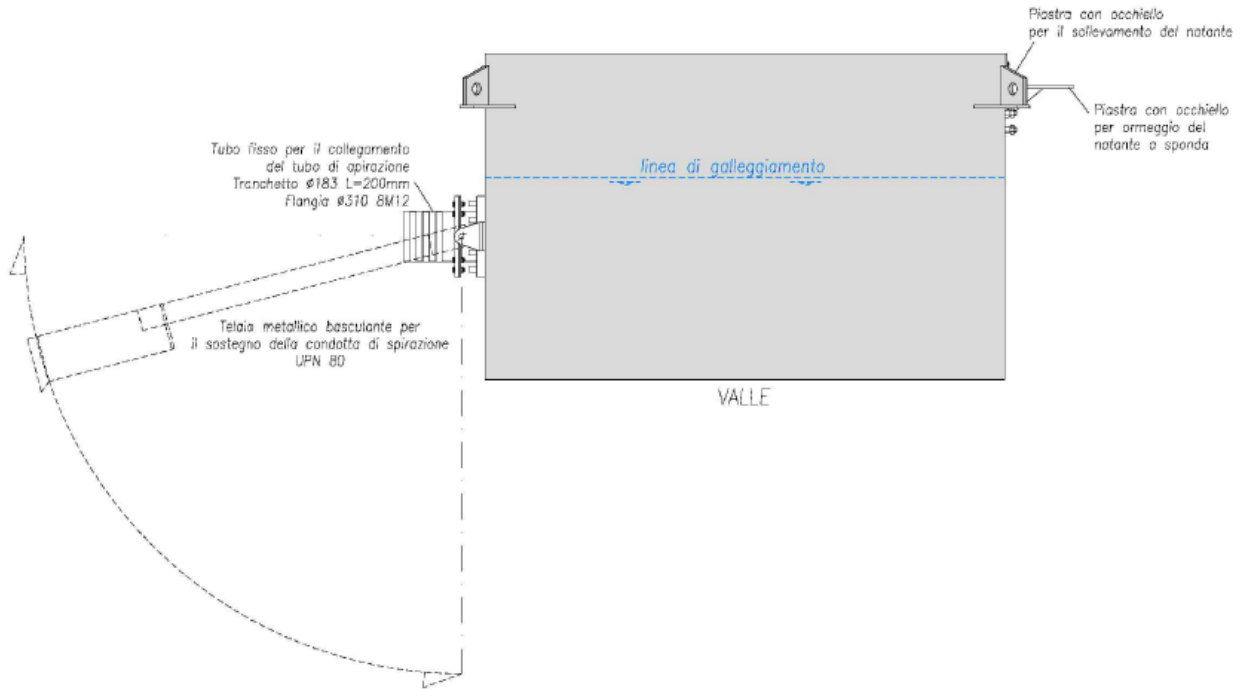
Prospetto laterale stazione pompaggio galleggiante - valle
